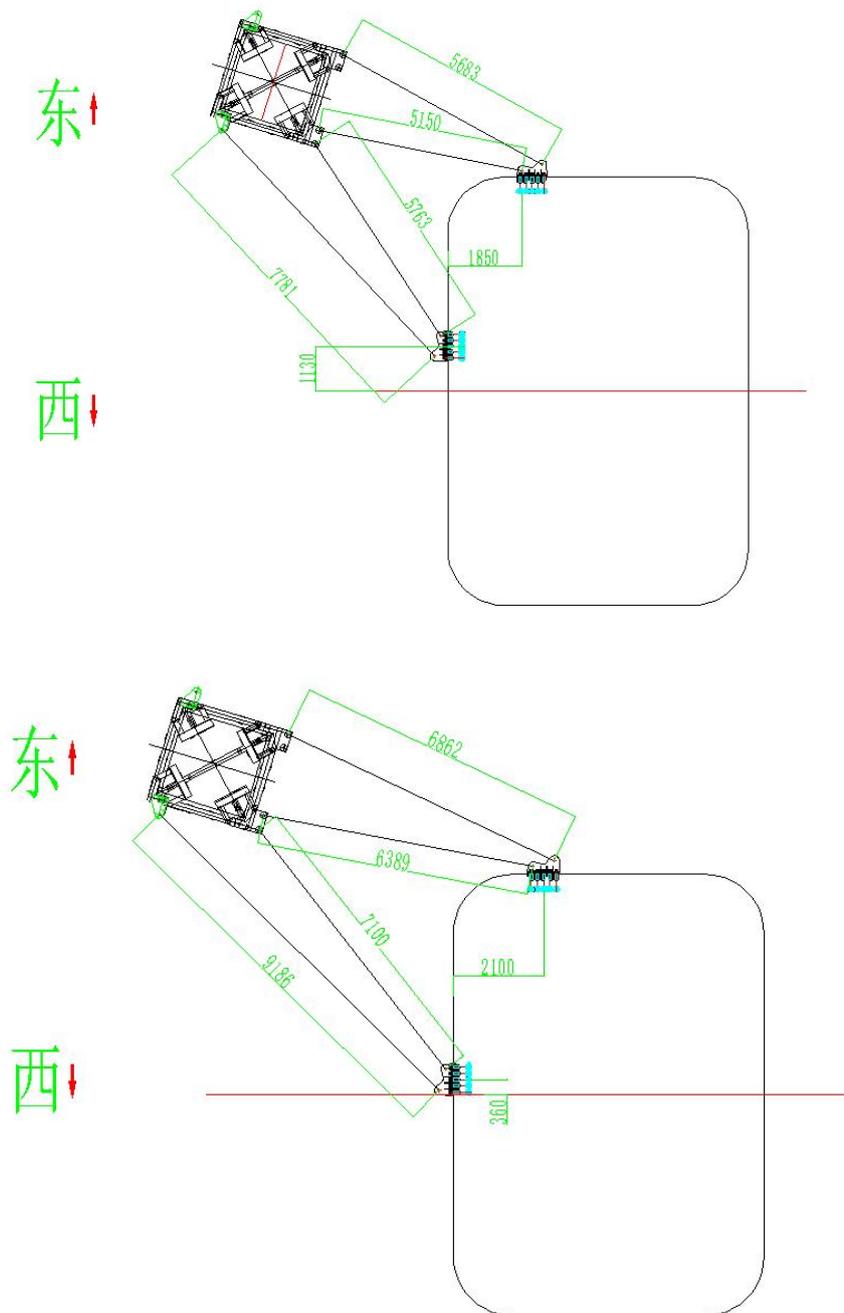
3#塔机第一，二道附着平面布置图
